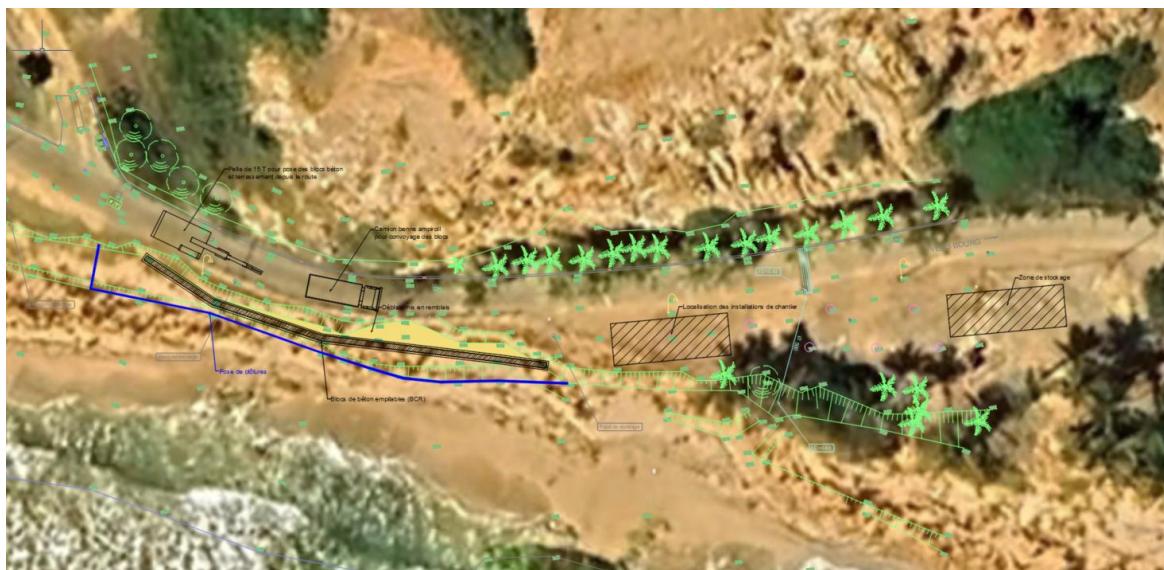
Plan des installations de chantier (Source : Suez Consulting)
